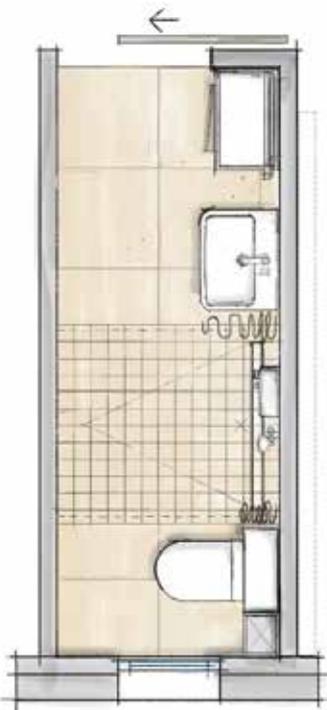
Umbauvariante 3 – Schlauchbad mit Assistenz an Waschtisch und Toilette (Grundriss: DLW)
